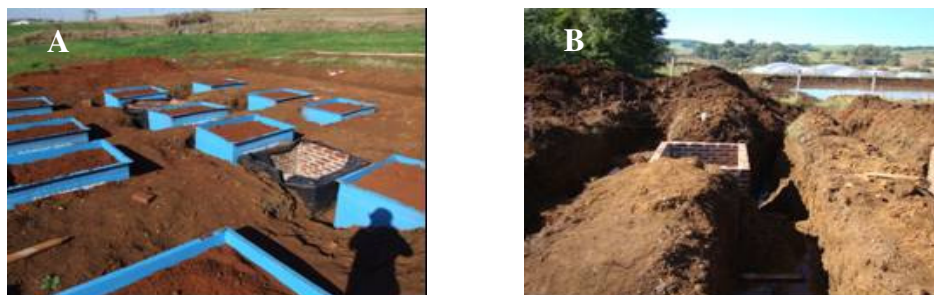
Vista parcial da construção do poço de observação em alvenaria.
